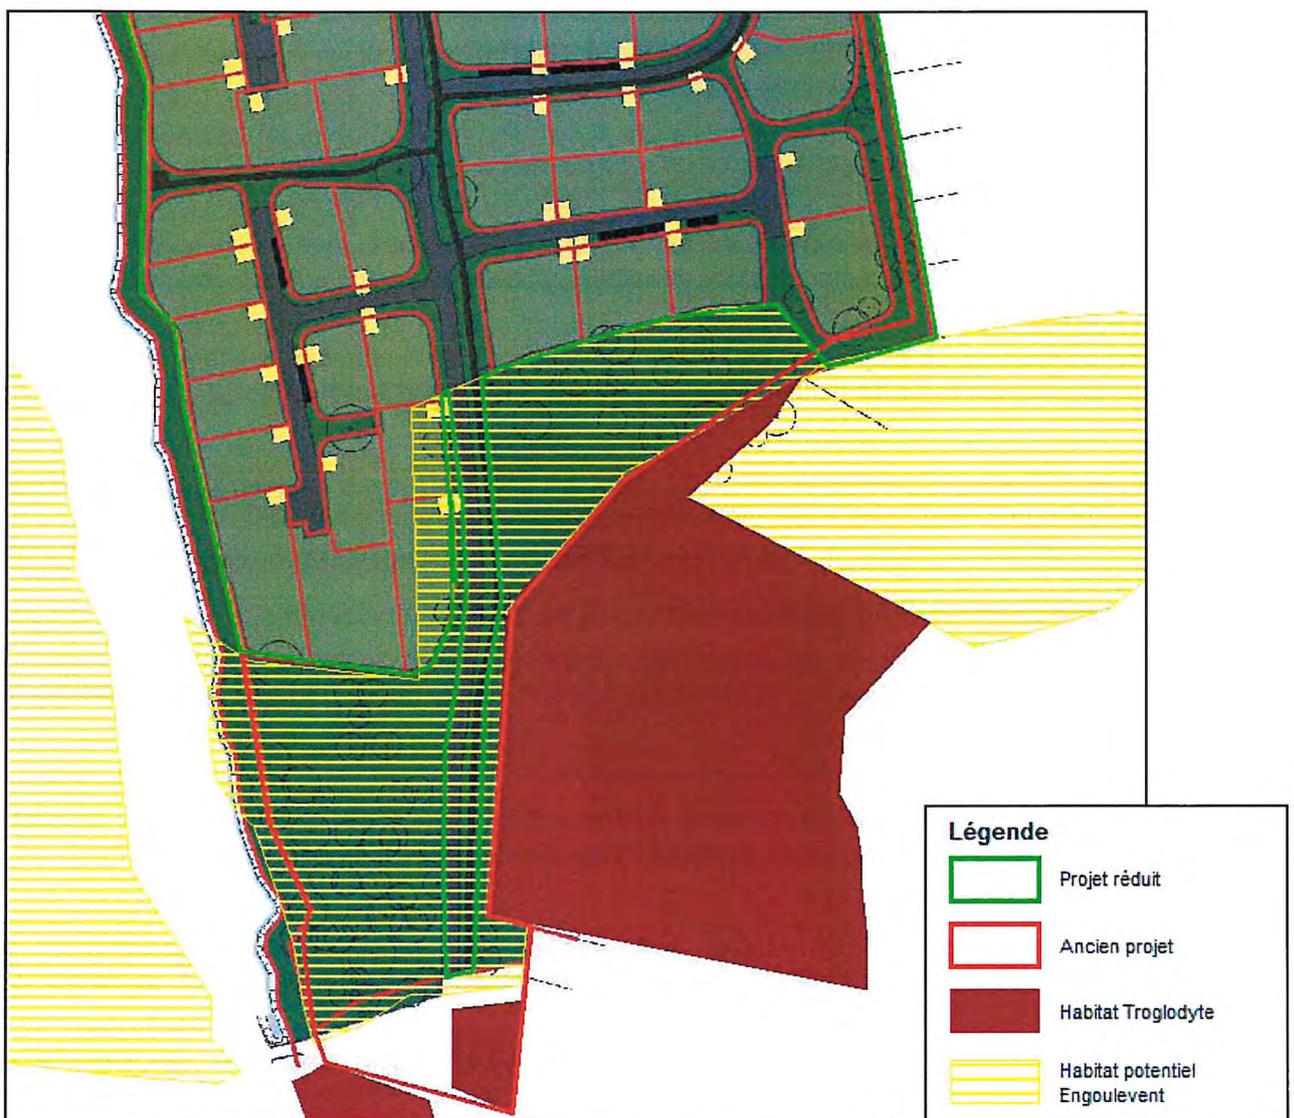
Habitat de l'Engoulevent sur nouveau plan de masse
